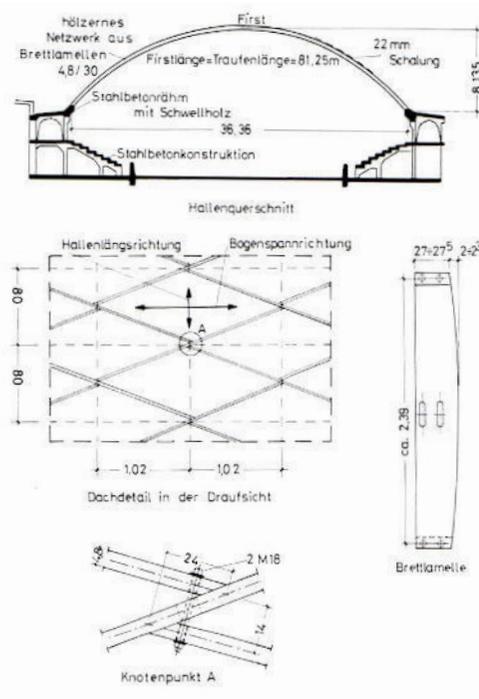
Münsterlandhalle, Münster, Querschnitt
